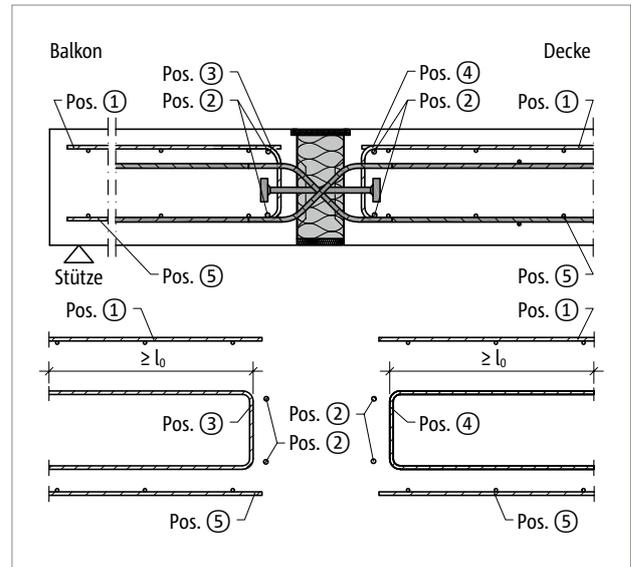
Schöck Isokorb® T Typ Q-P-VV: Bauseitige Bewehrung
